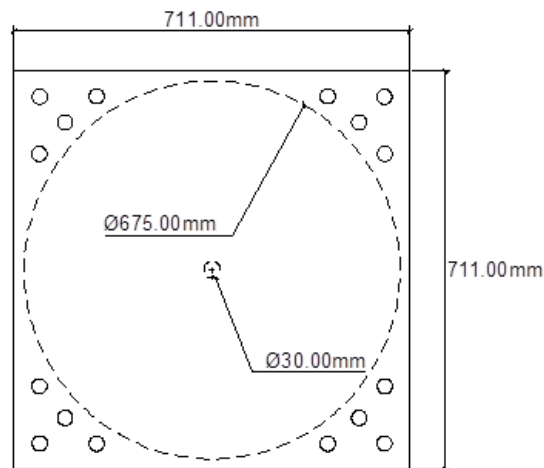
Dispositivo aislador HL075X4R – Vista en planta
